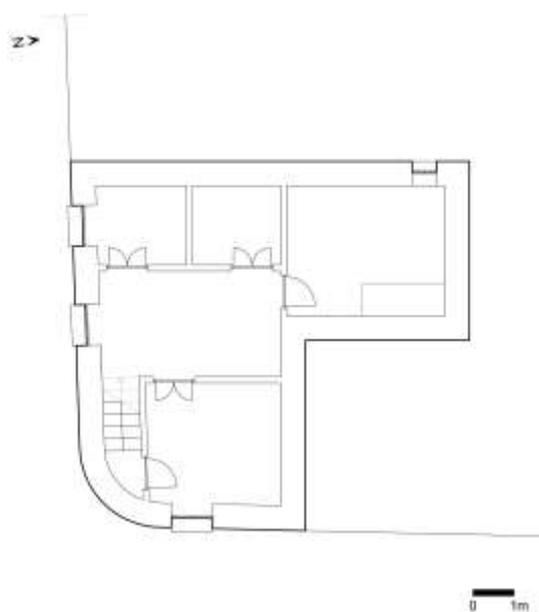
Planta do Piso 1. Piso habitacional. (Ilustração nossa, 2021)
